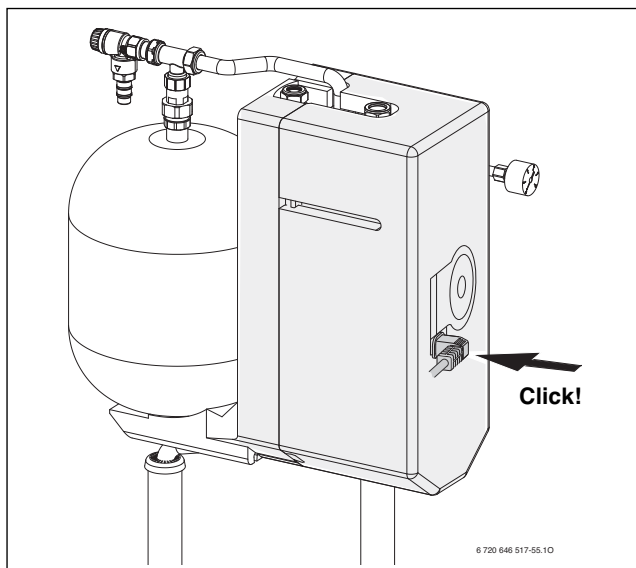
GB172-.. T210SR: Možné místo montáže SM10
